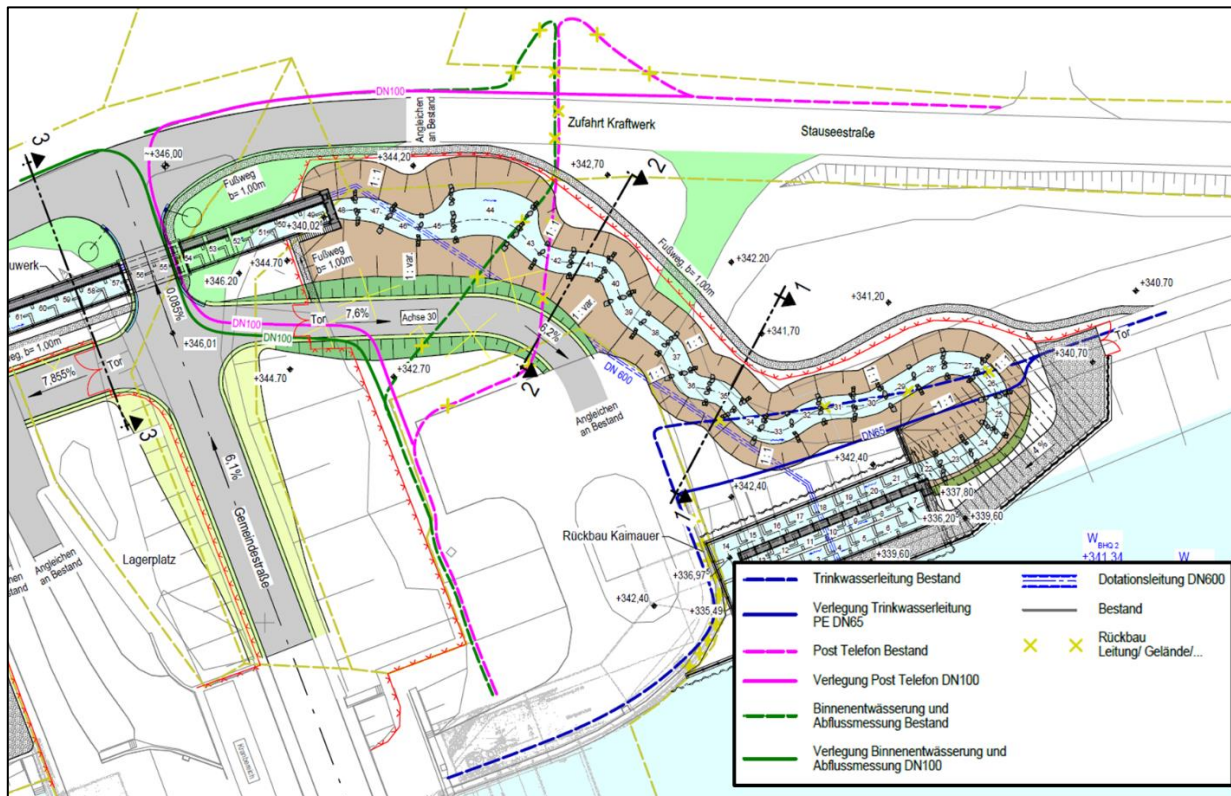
Lageplan betroffener Sparten und deren geplante Verlegung
